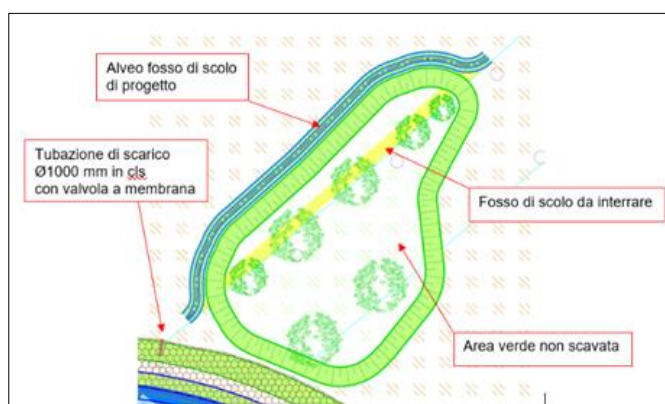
Area verde interna alla cassa di espansione non soggetta a scavo
